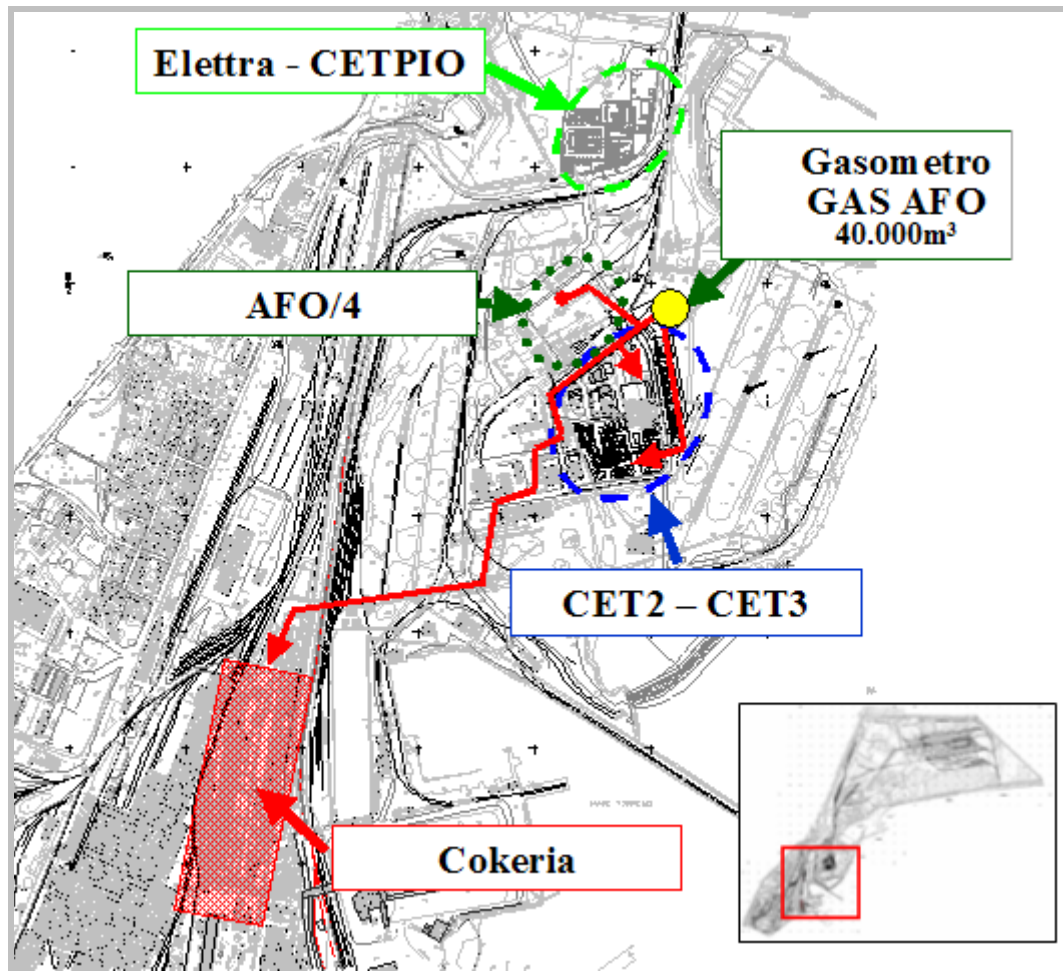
Planimetria semplificata della rete di distribuzione del Gas AFO
